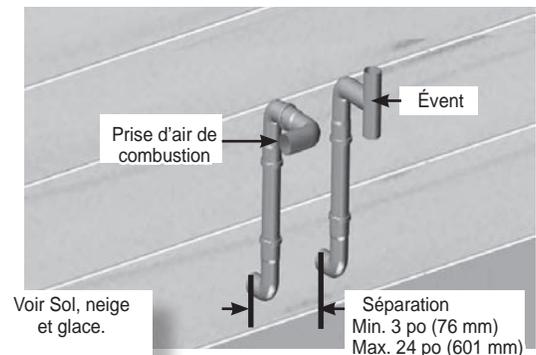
Pipe de Bouche w/Horizontal T
